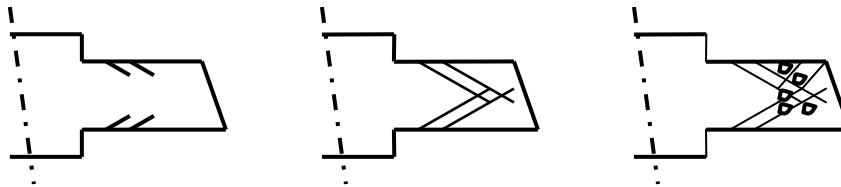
l'absence d'armature transversale, le cisaillement alterné détruit les sections.
